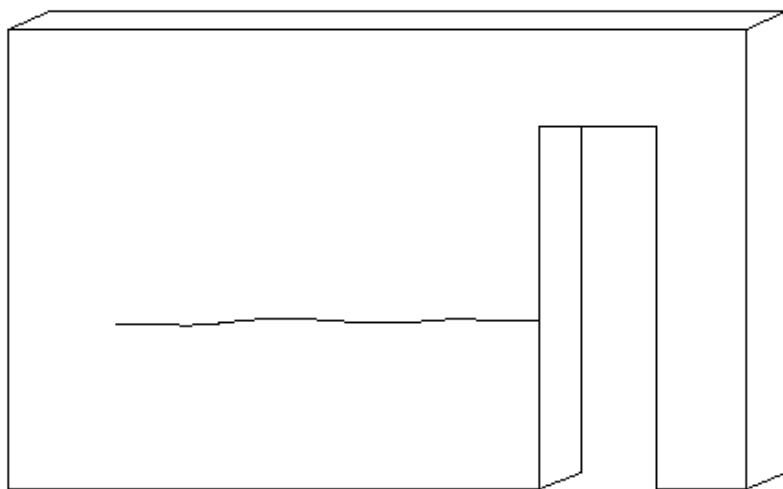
Ejemplo de fisura horizontal en la cercanía de una puerta por un incorrecto adhesivo del ladrillo en la junta horizontal.
